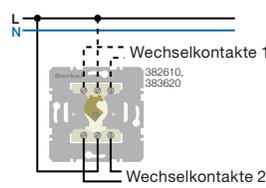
Wechselschalter 1- und 2-polig für Schließzylinder [Best.-Nr. 3826 10, 3836 20]
